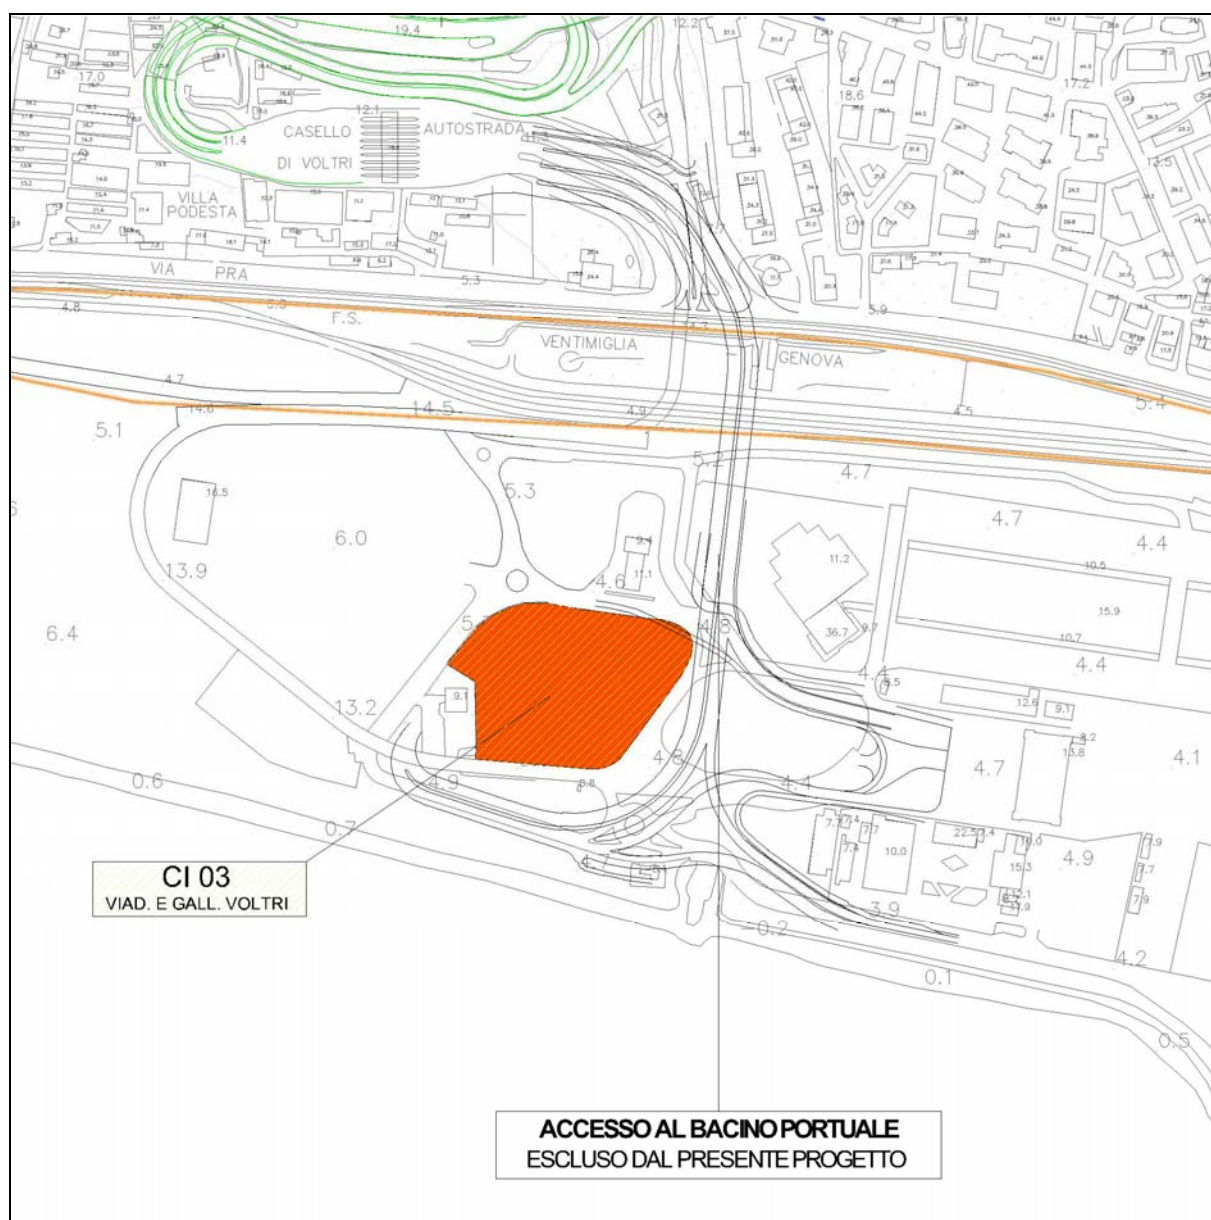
Il cantiere previsto dal Progetto Definitivo del Nuovo Viadotto di Accesso alle aree portuali di Voltri
